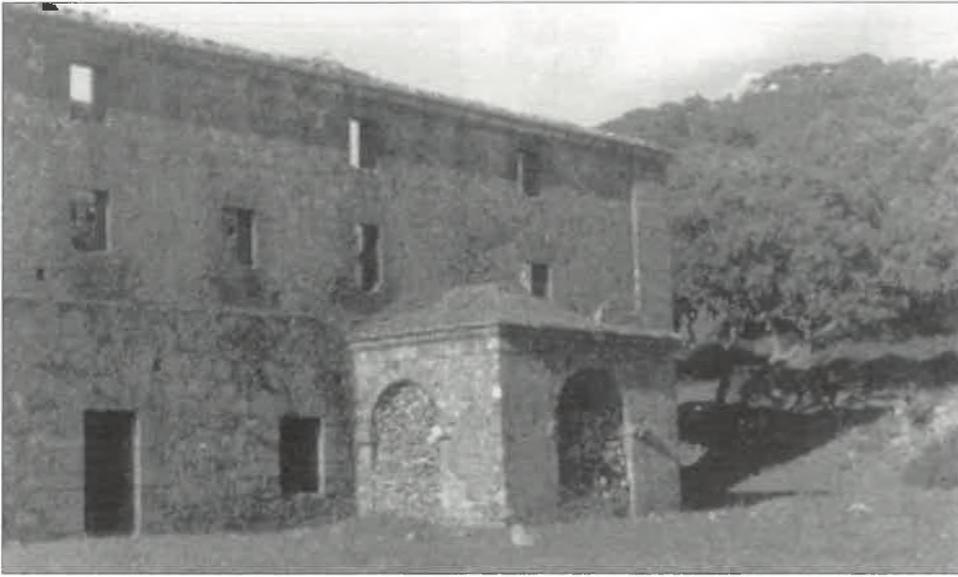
Primer plano del zaguán porticado en la fachada NW.
